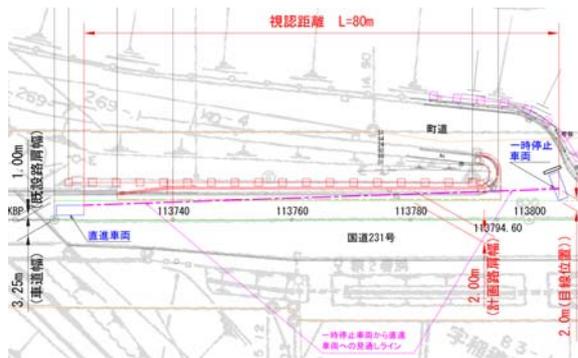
国道 231 号増毛町箸別交差点 路肩拡幅平面図
